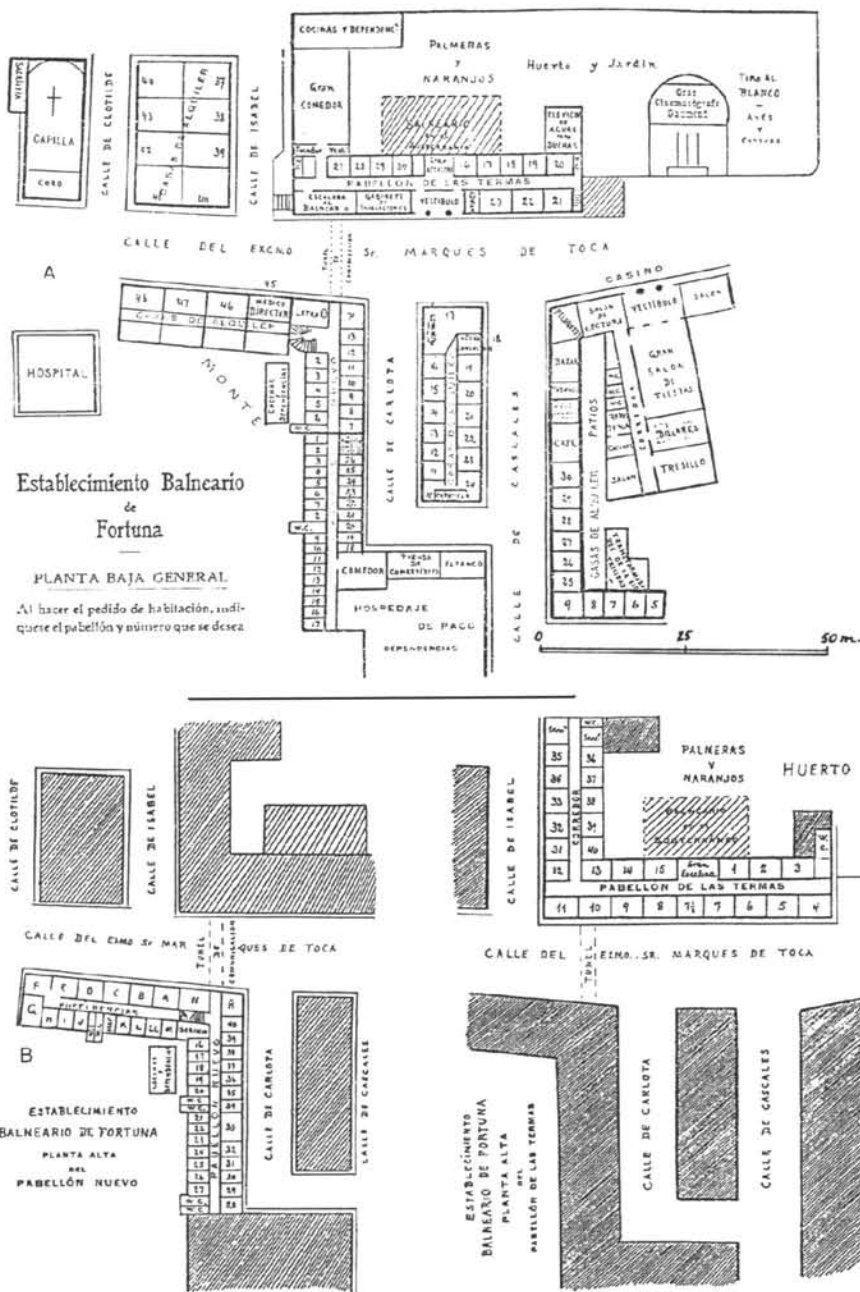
Plano general del Establecimiento Balneario de Fortuna (A) y Planos de la planta alta del Pabellón Nuevo y del Pabellón de las Termas (B), en el año 1906.
